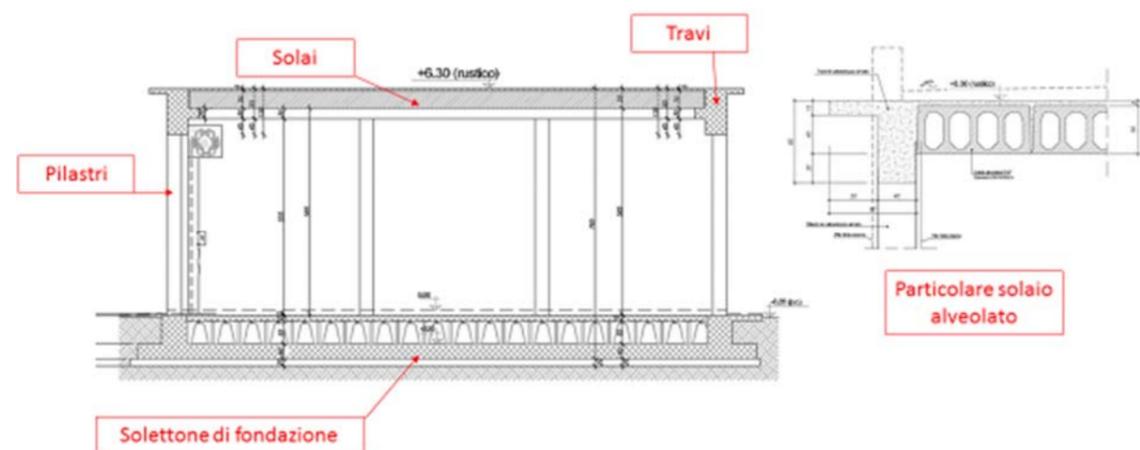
Vista in sezione della struttura della stazione VV.FF
